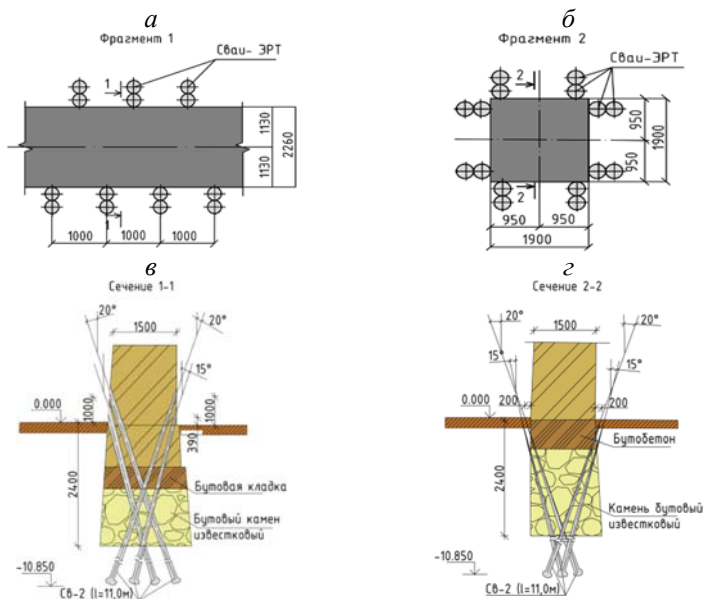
Схема расположения буроинъекционных свай при усилении основания и фундаментов усиления ЭРТ (РИТ, ЭРСТ, ФОРСТ):
